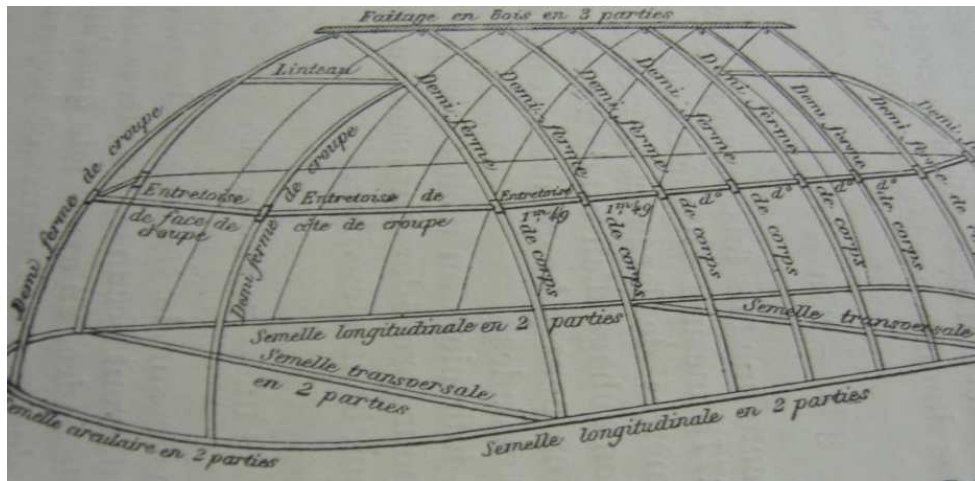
Armatures de la tente Tollet, autre construction légère et démontable, schéma d'époque.
